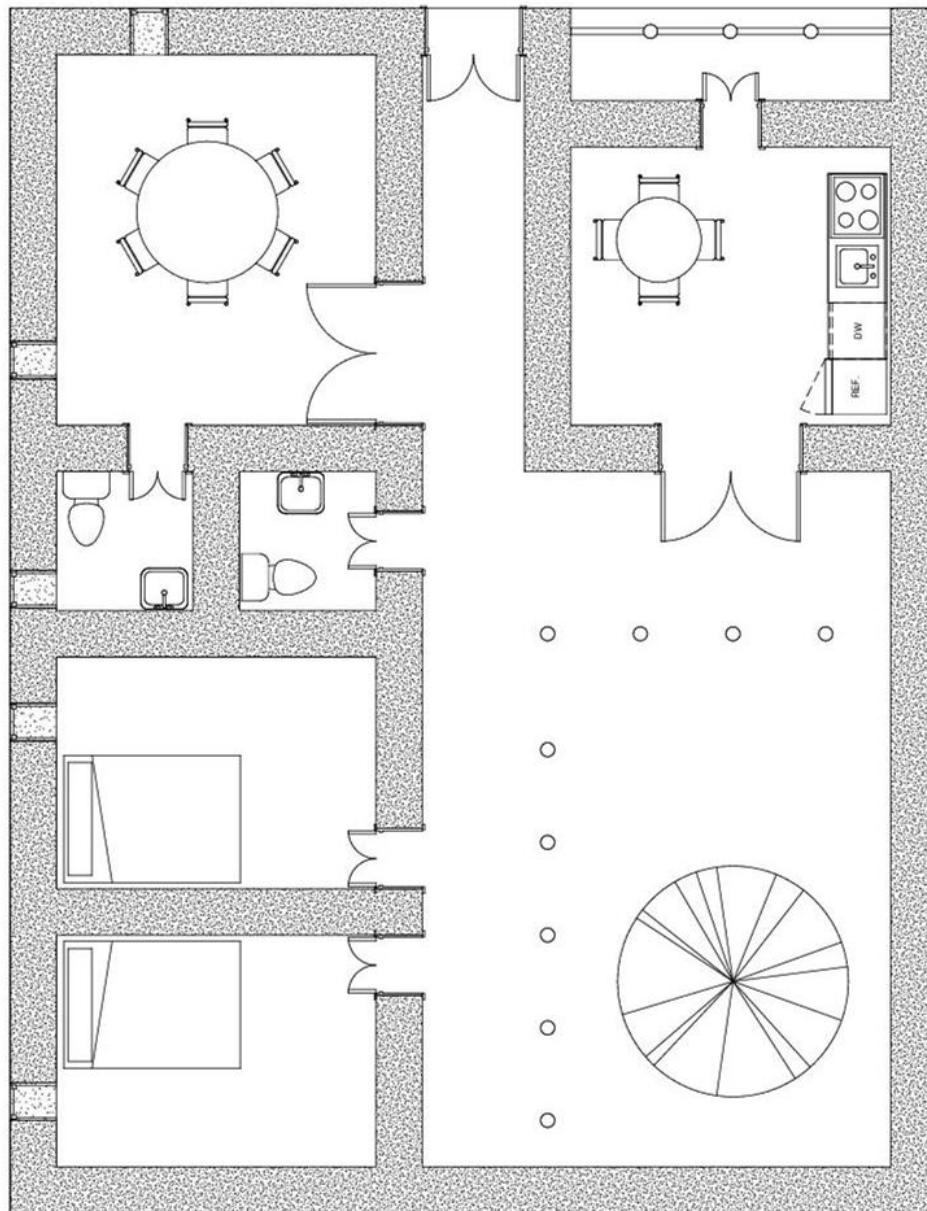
Planta arquitectónica del Modelo 1 - Boyacá. Fuente: Elaboración propia.
